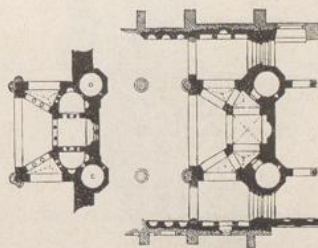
Grundriß vom Erdgeschoß und Empyre im Westchor zu Essen.
